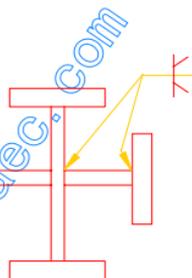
十字形组合柱的组装焊缝
